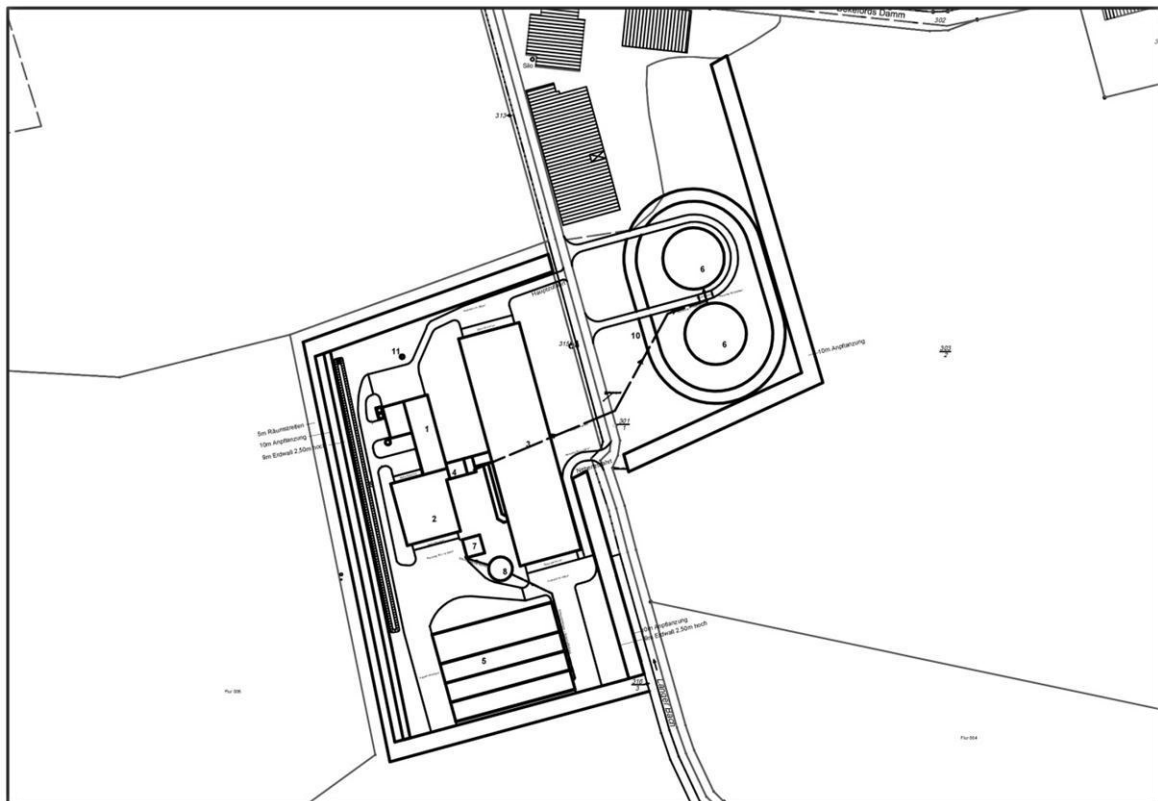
Lageplan des geplanten Vorhabens (verändert nach InnovationsTeam Christiane Brandes).
